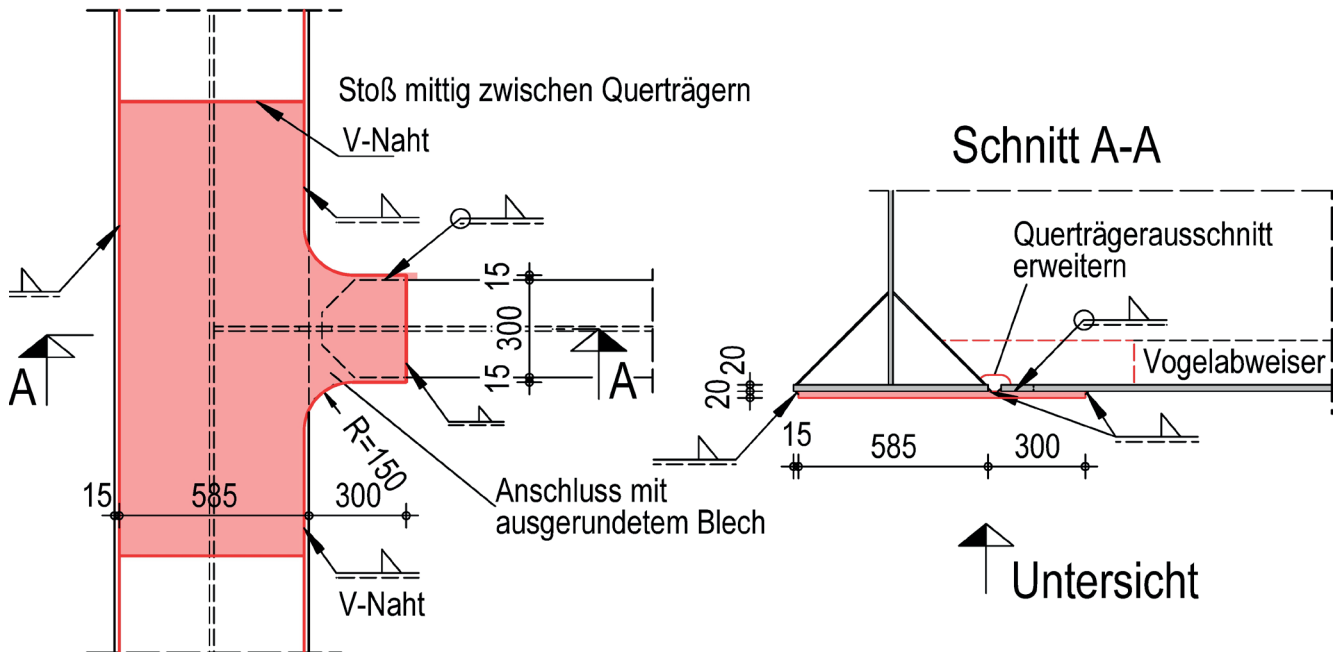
Umbau des Querträgeranschlusses gemäß Ausführungsplanung
